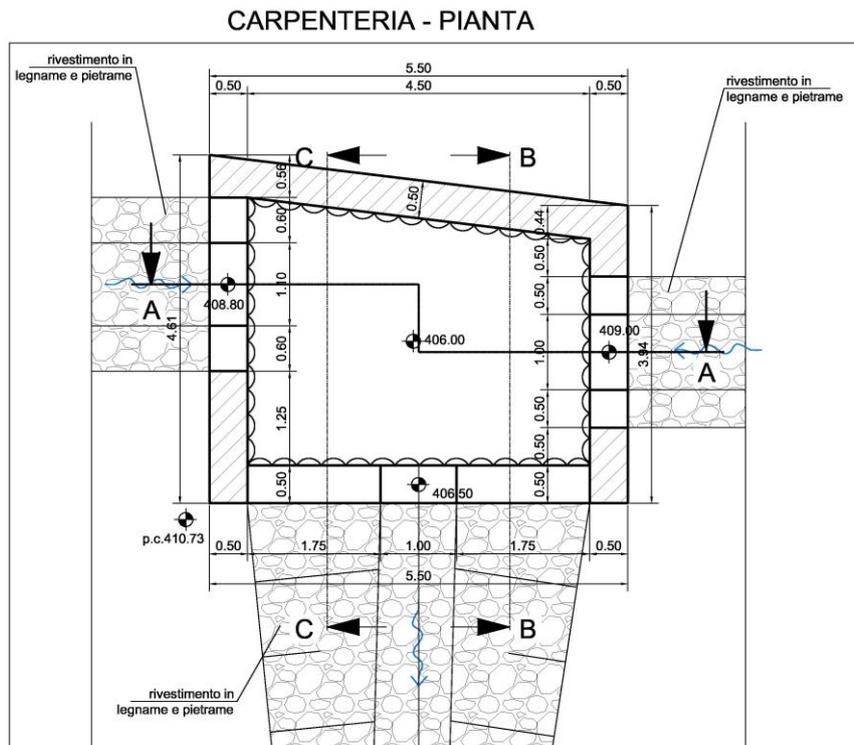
Compluvio centrale – Vasca Vi5 - pianta
